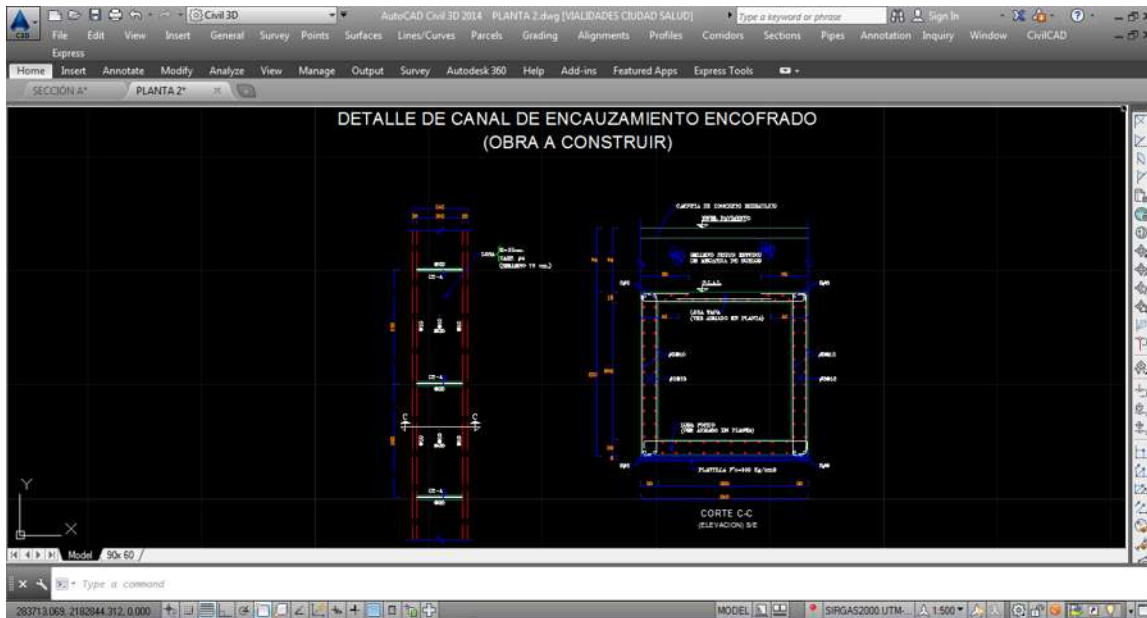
DETALLE DE CANAL DE ENCAUZAMIENTO ENCOFRADO (OBRA A CONSTRUIR).
